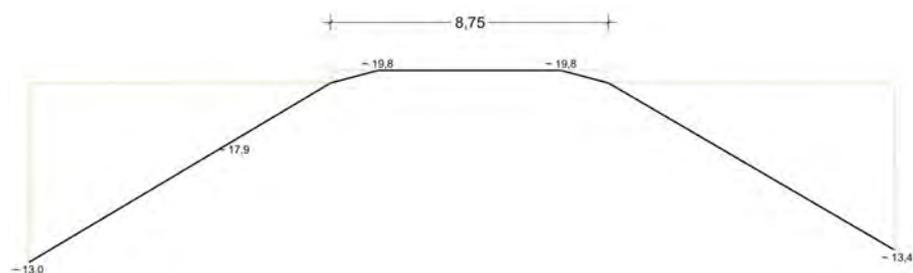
Querschnitt Q4 - Querprofil Bestand
